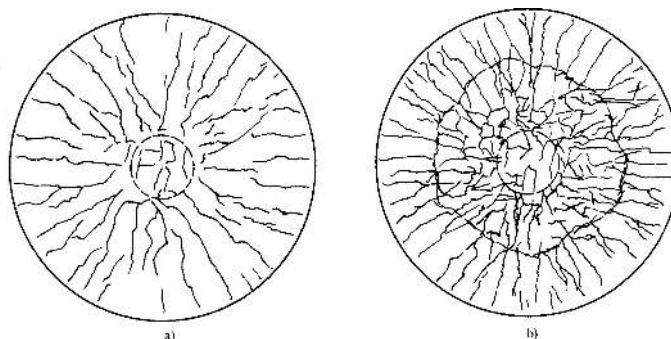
Fisurarea unei dale în jurul stâlpului [23]
